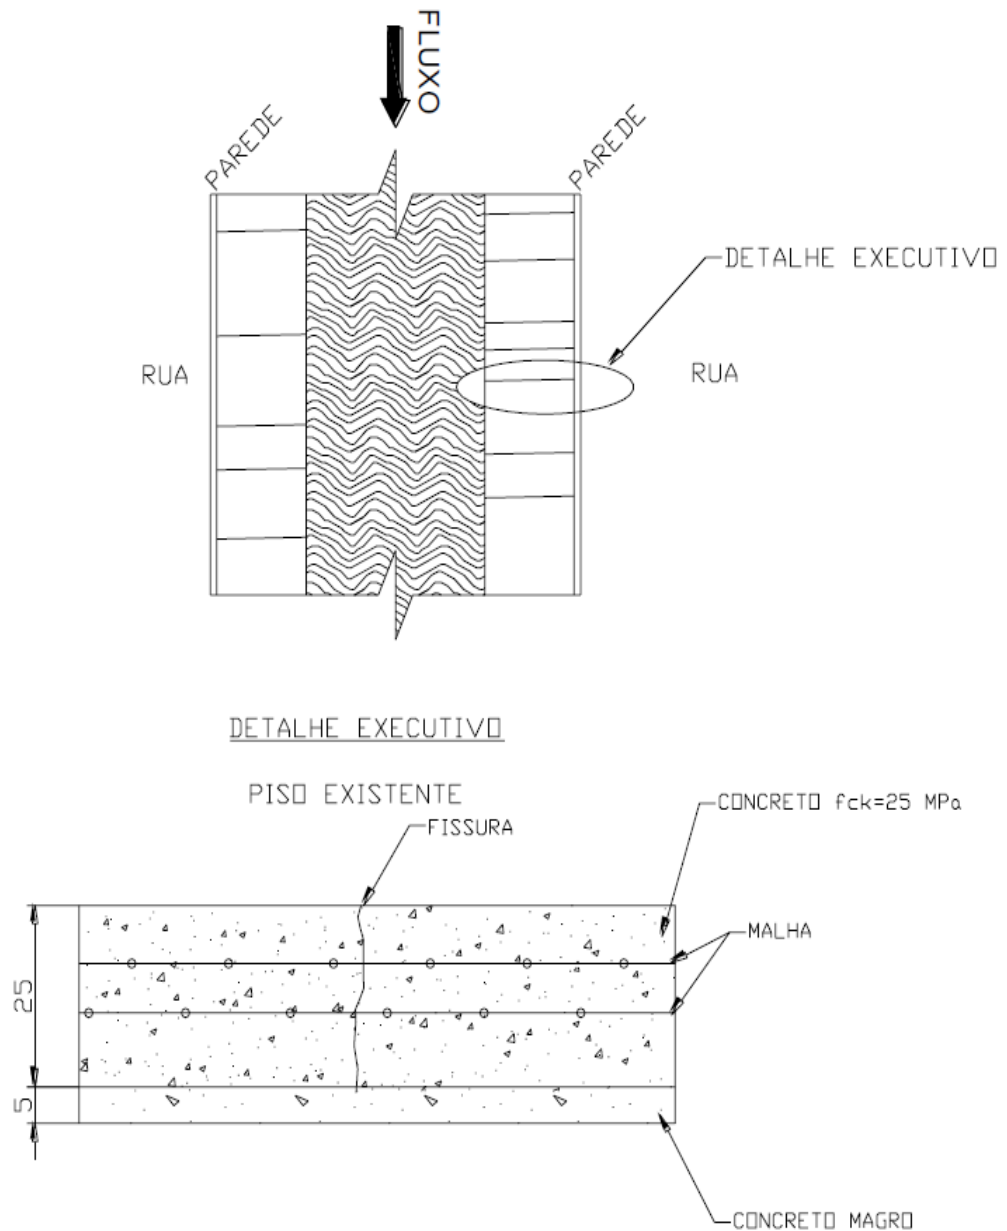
Detalhe executivo da recuperação da laje de fundo do Ribeirão Arrudas (Fonte: ACERVO PESSOAL, 2009)
